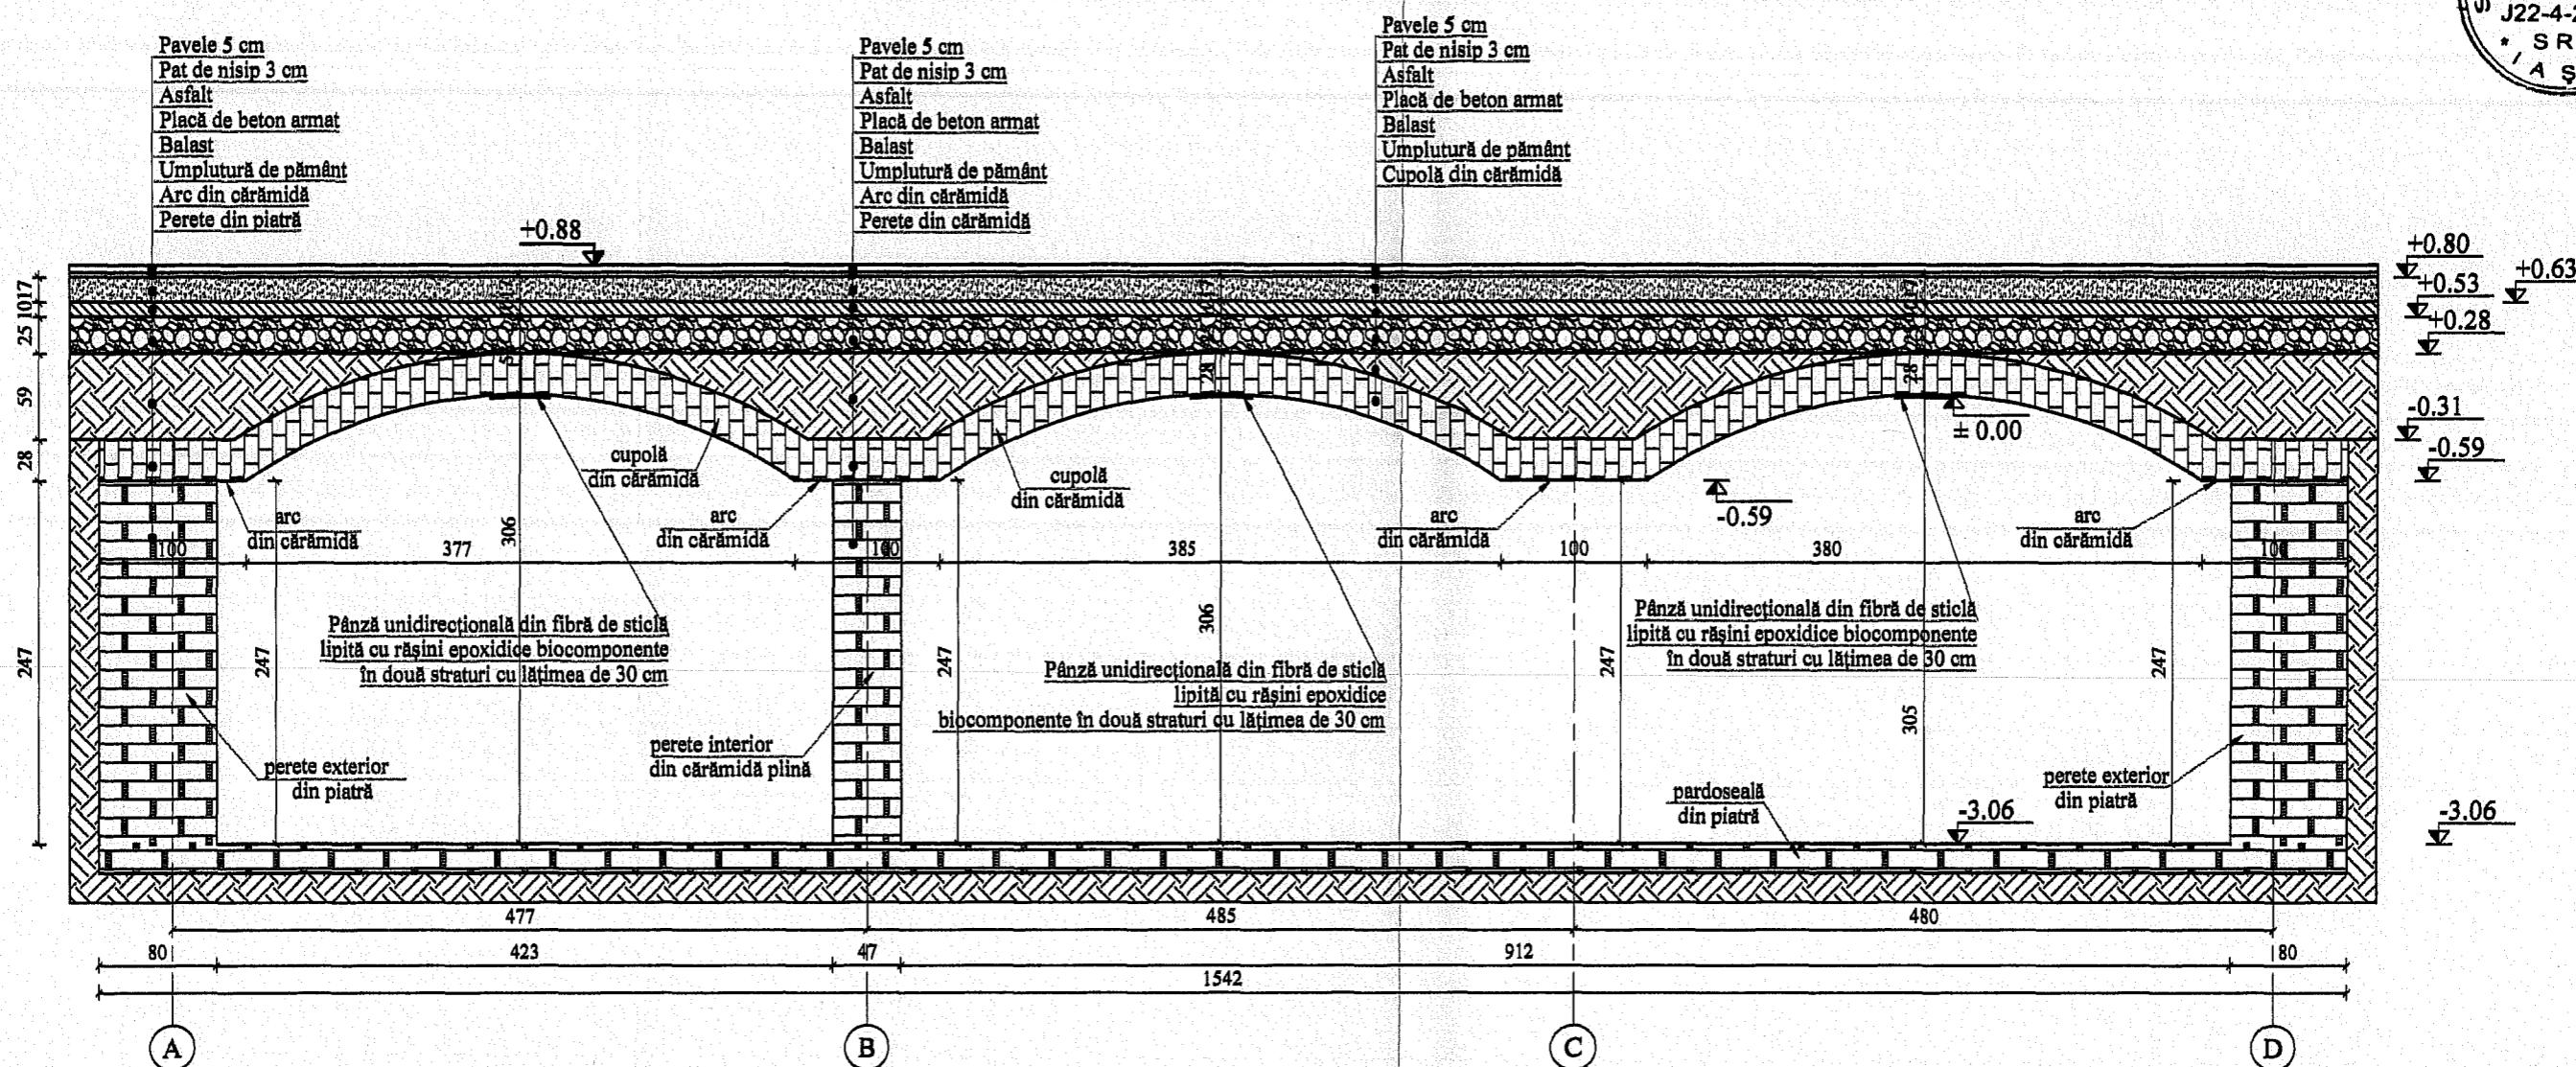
SECTIUNE LONGITUDINALĂ C-C - SITUAȚIE PROPUȘĂ
